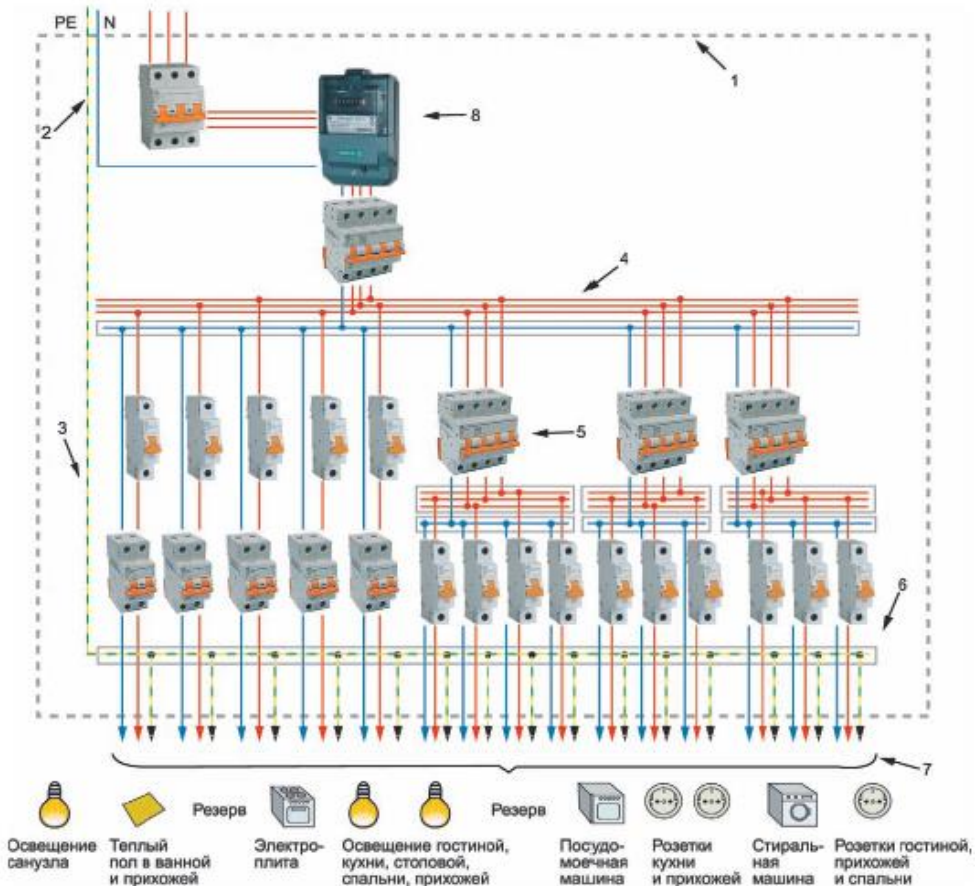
Трехфазная схема щитка в частном доме с разделенным проводником нейтрали и заземления: 1 — пластиковый или металлический корпус щита; 2 — соединительные элементы нулевых рабочих проводников; 3 — соединительный элемент РЕ-проводника, а также уравнивания потенциалов; 4 — соединительный элемент фазовых проводников групповых сетей; 5 — выключатель дифференциального тока; 6 — автоматические выключатели; 7 — линии групповых цепей; 8 — дифференциальный автоматический выключатель; 9 — счетчик.
